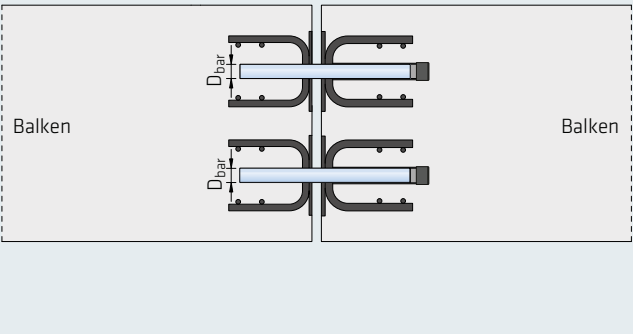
Mindestabmessungen bei Balkenverbindungen
